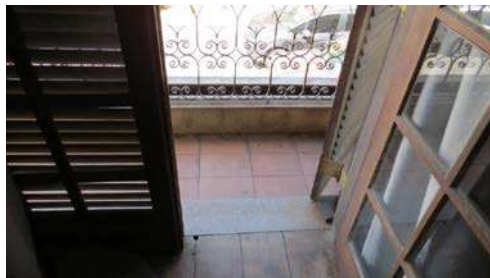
Vista do dormitório 02 no 2º pavimento
